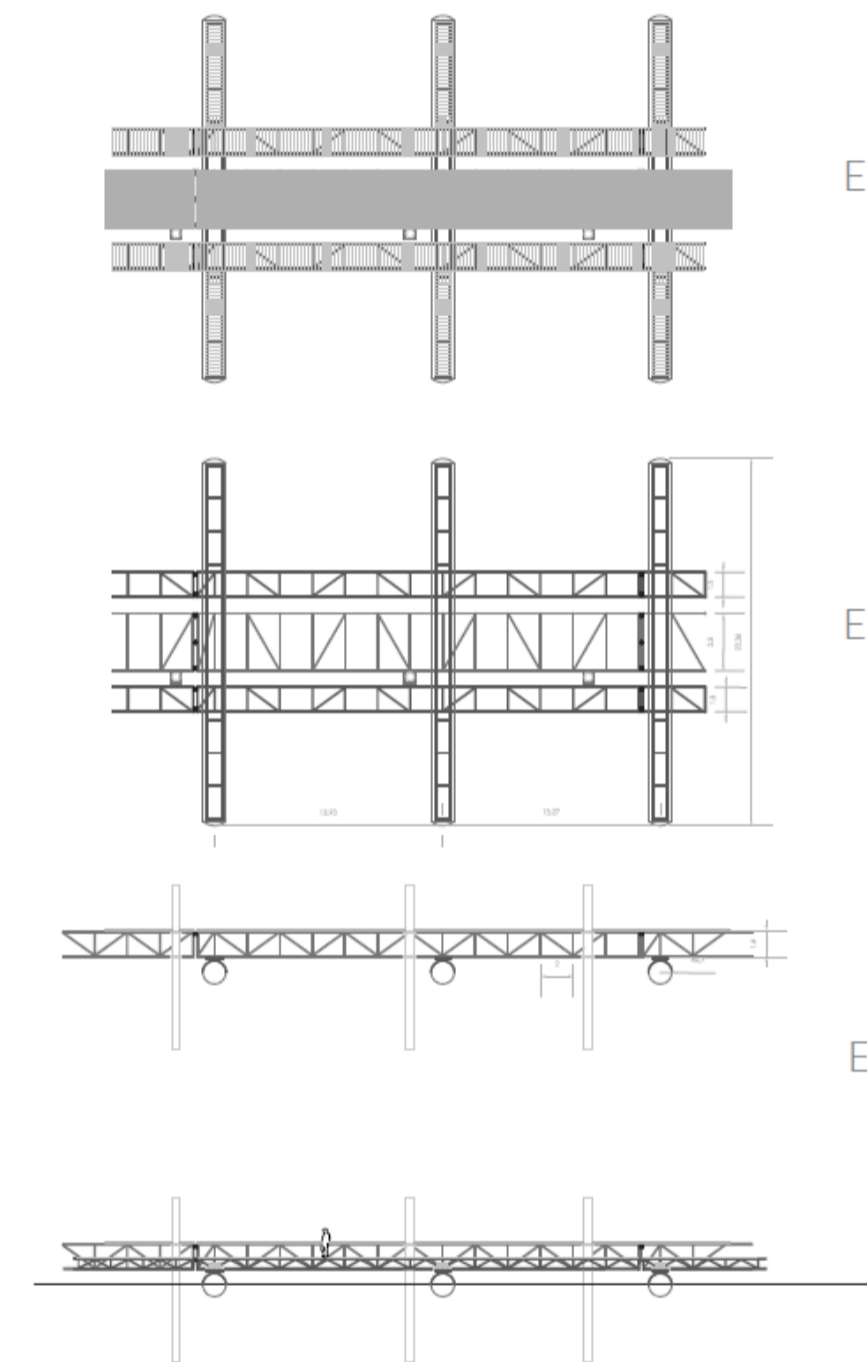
Dibujos del Autor - Detalles planimetricos muelles "fingers Dobles"
